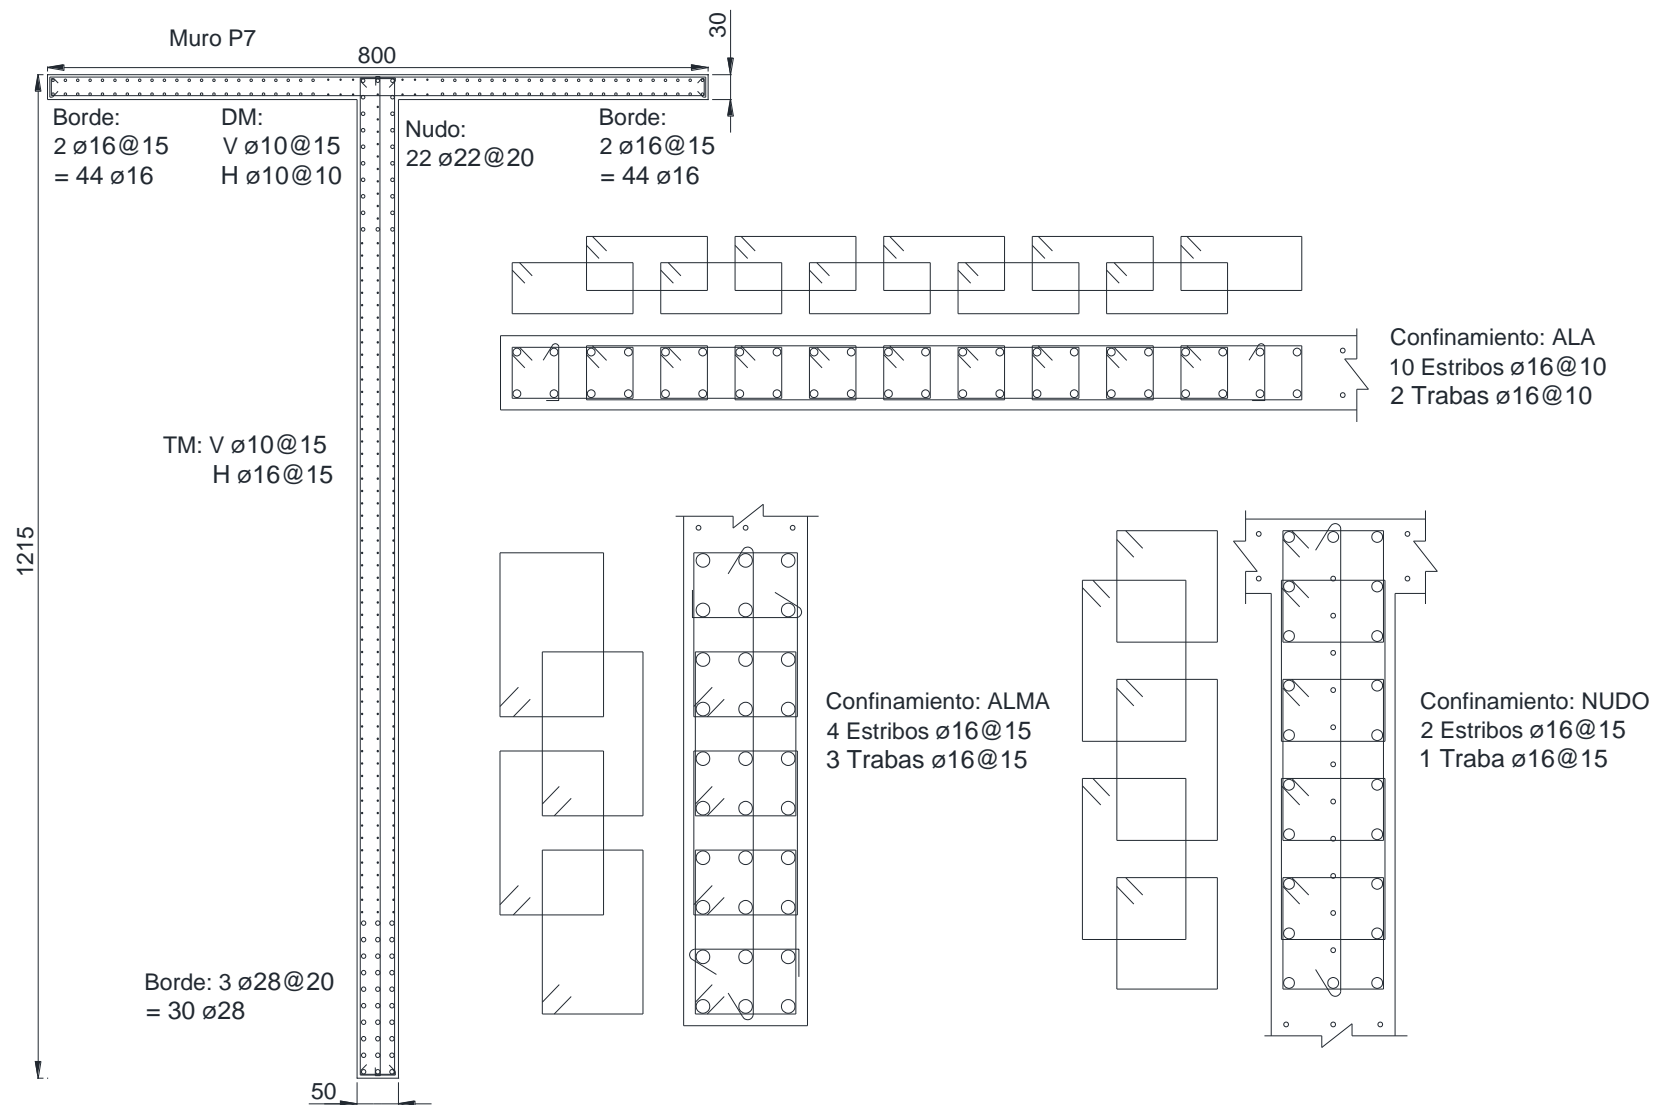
Armadura longitudinal, transversal y de confinamiento para el muro P7
